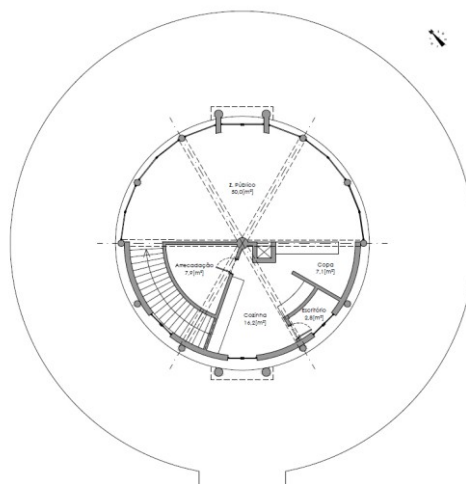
ERB* (EXISTENTE) PLANTA PISO 1 [VLÓIO, 2011].
